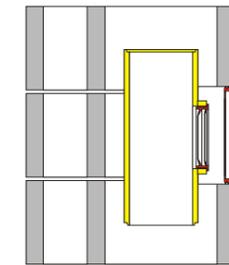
Feuerstättenanschluss rund, 90°/20 mm lang
